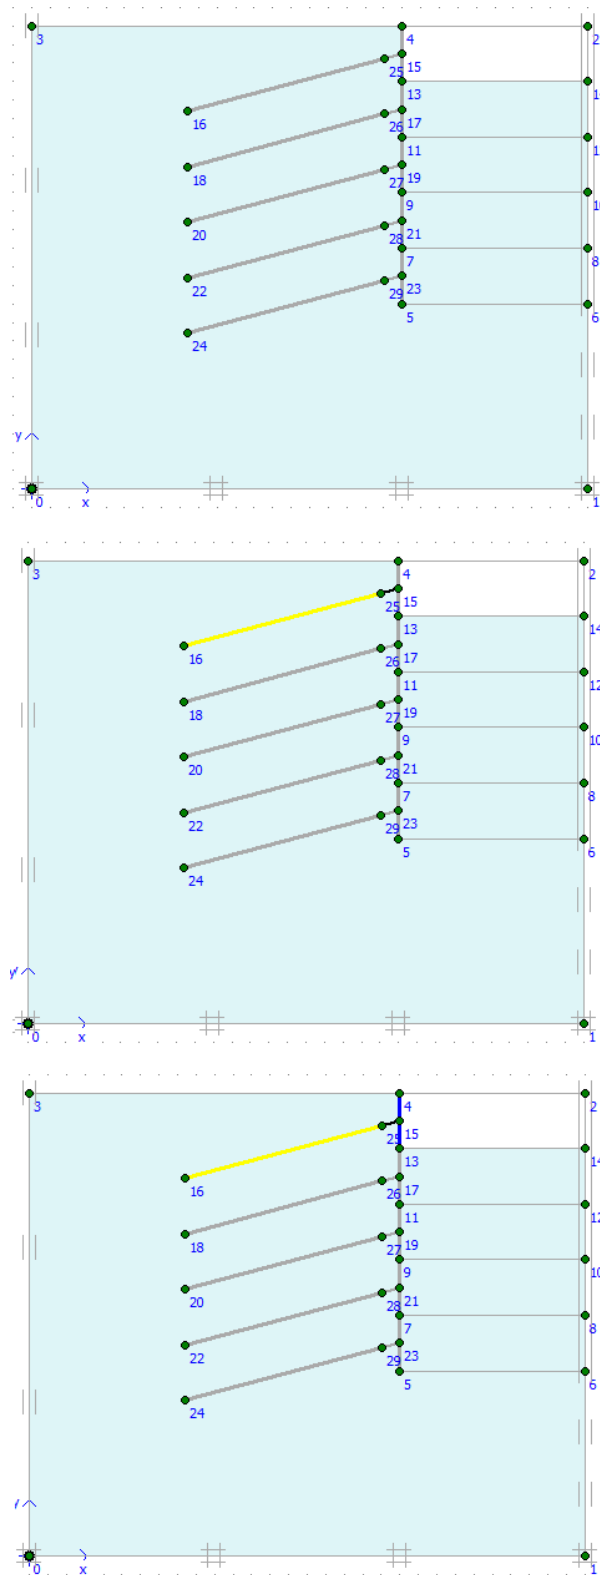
Fase 1: Escavação, instalação do grampo e revestimento com concreto projetado
